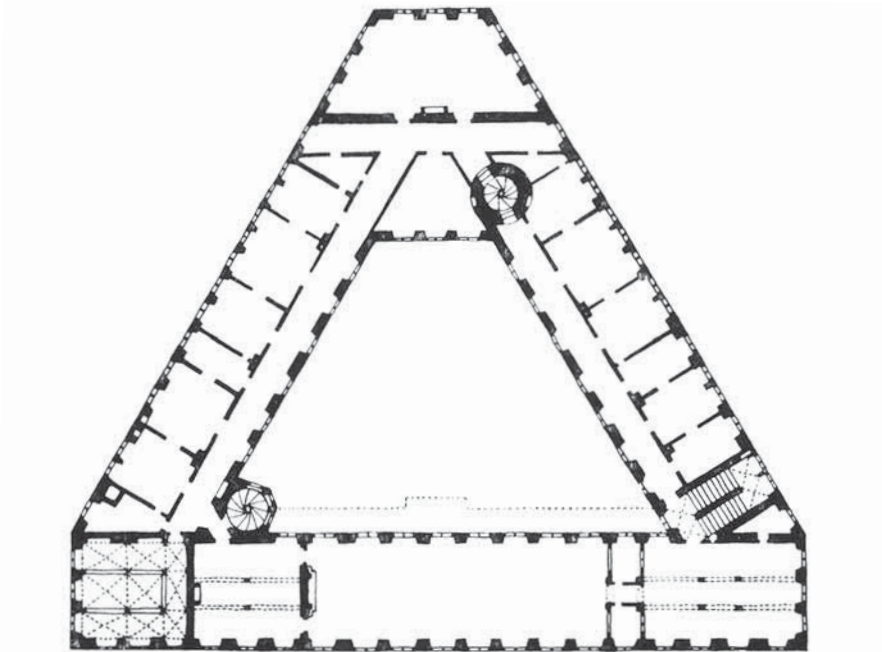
Schloss Weikersheim, Grundriss des 1. Stockwerks nach dem Plan von Georg Stegle (Zeichnung: Walther-Gerd Fleck, Stuttgart)
